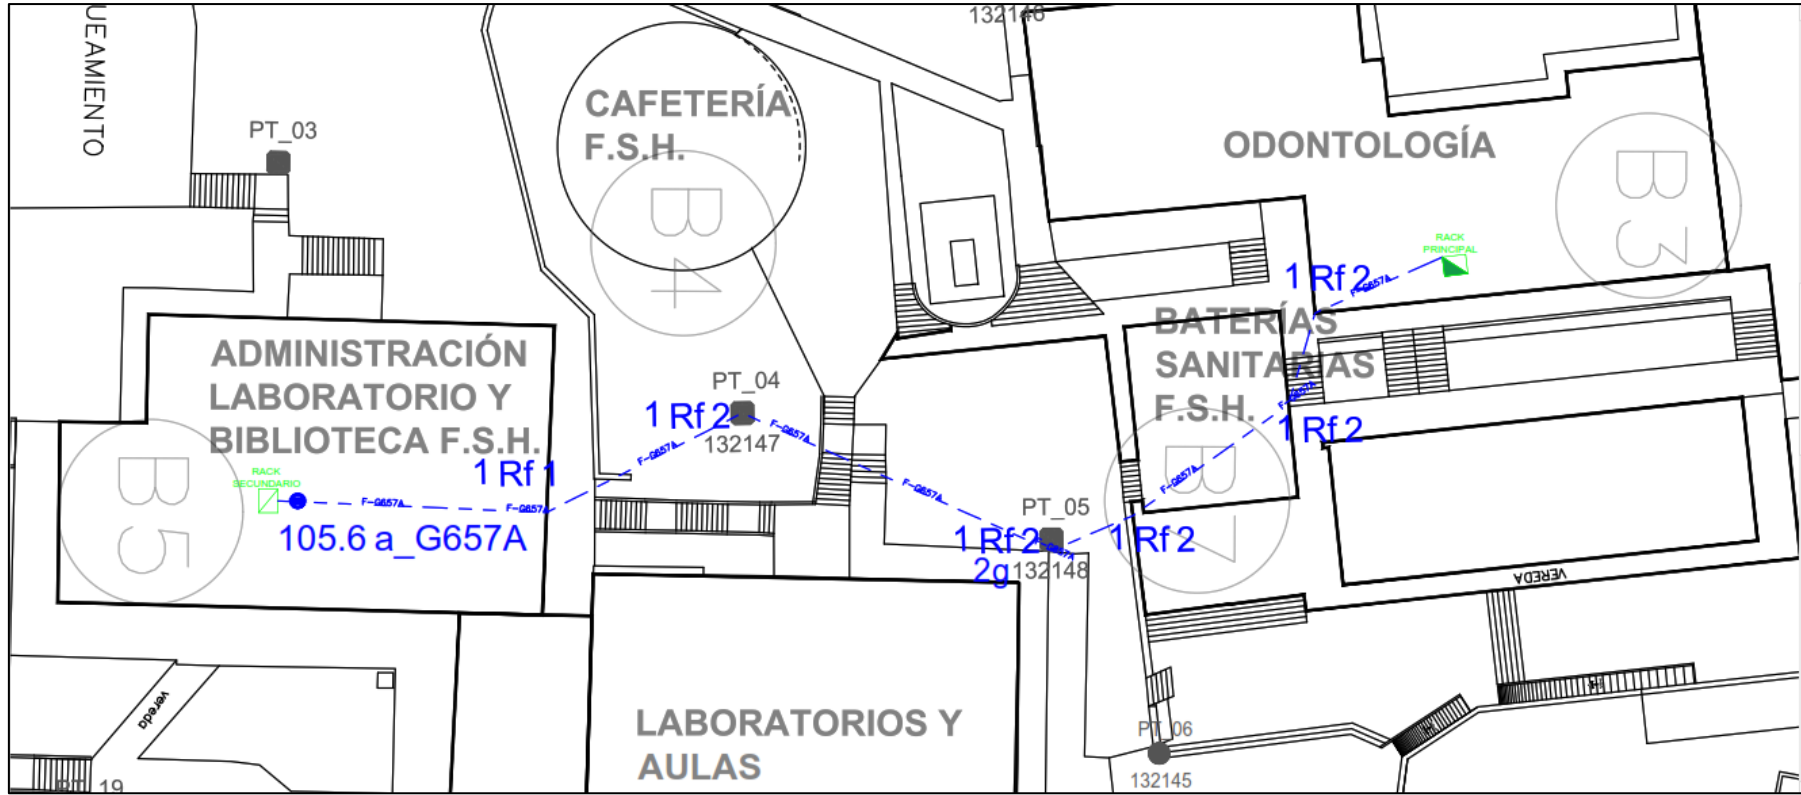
Planimetría del tendido aéreo para el enlace de fibra óptica del bloque 5.
